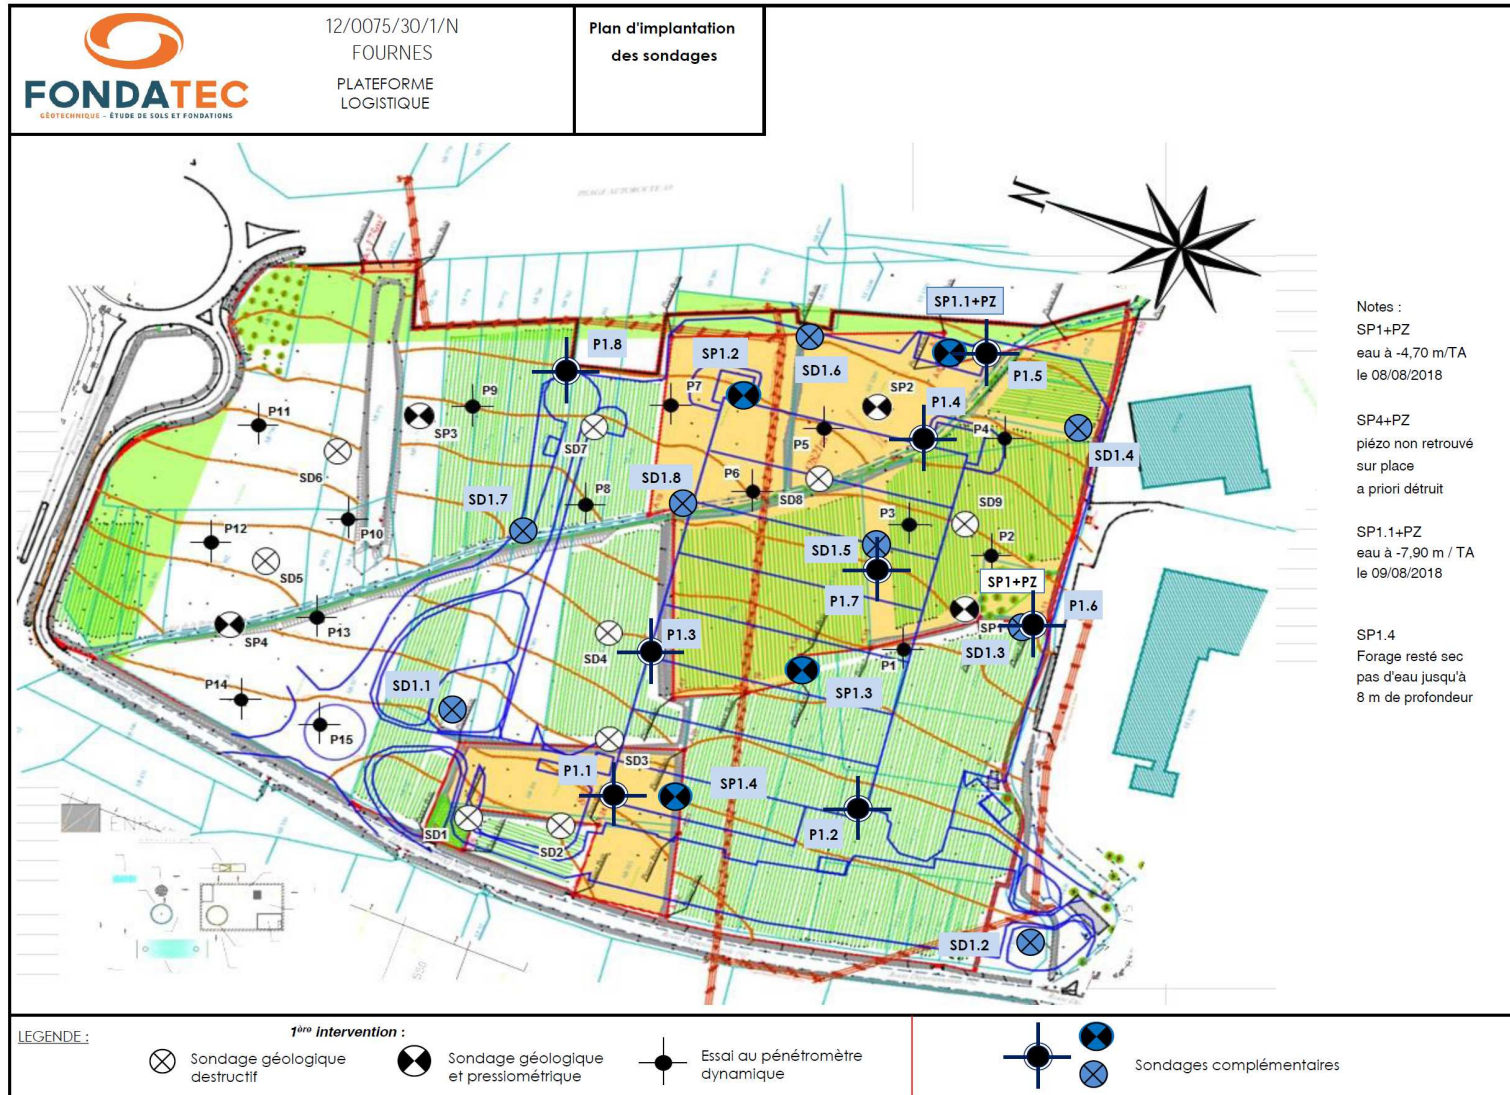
Plan d'implantation des piézomètres (Source : Fondatec)
